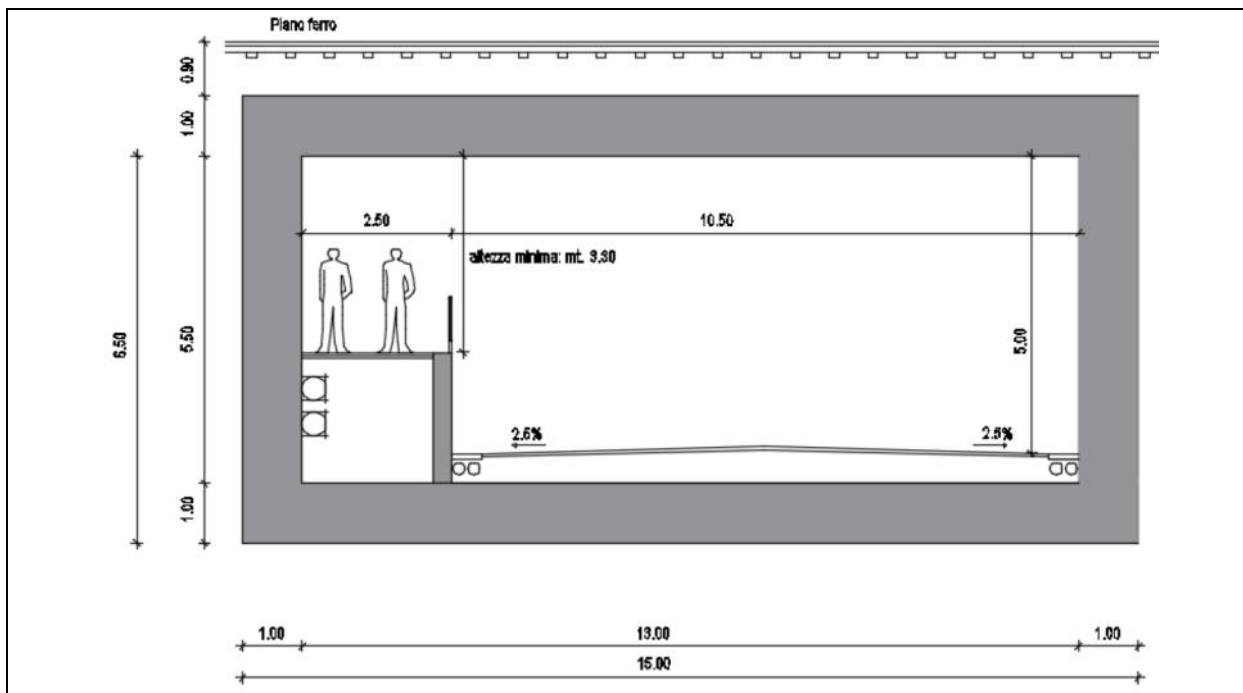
Sezione in asse attraversamento ferroviario al km 33+659.
